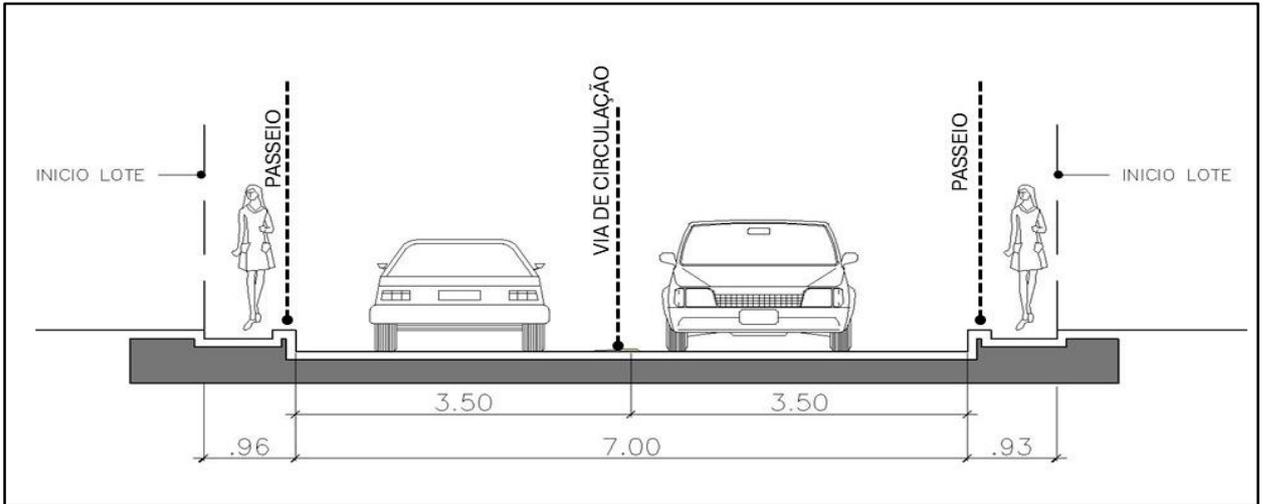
Perfil viário Via de circulação de vizinhança URB 154/18 (região cotada em projeto).
